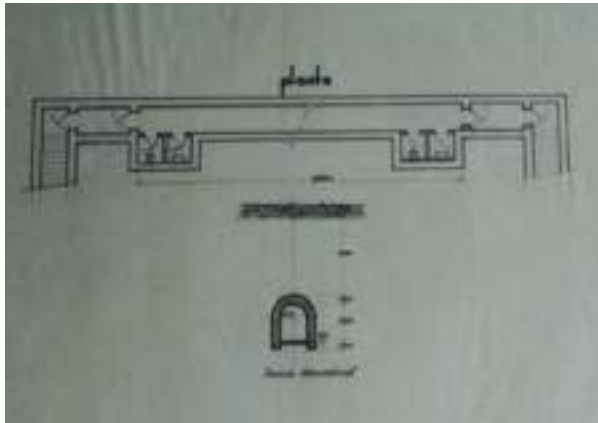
Planta del refugio bajo la Fábrica Payá
